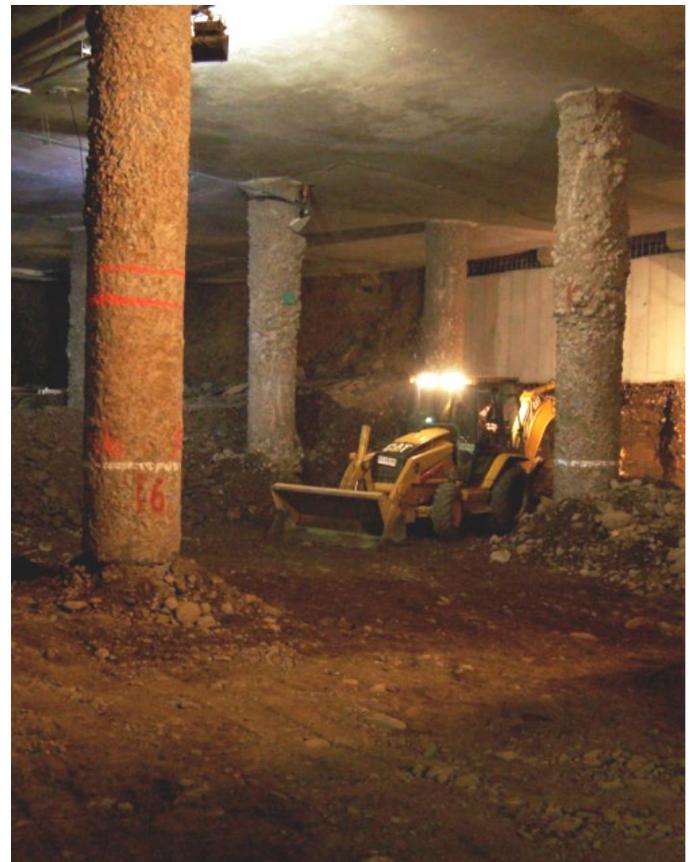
y 3 – Vista Excavación primer y segundo subterráneo.
